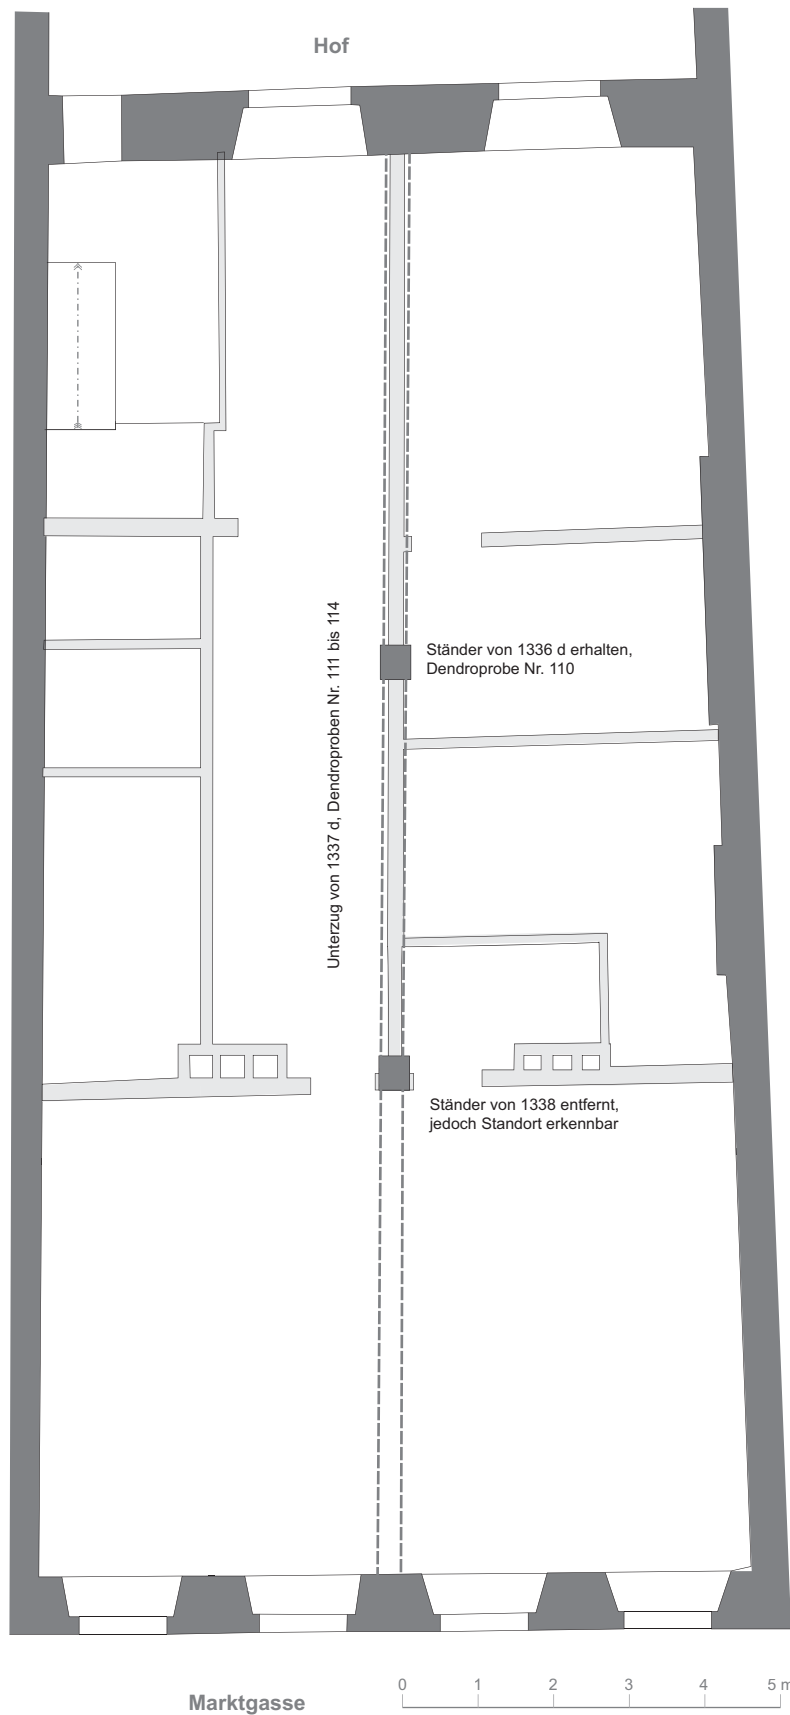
Winterthur. Marktgasse 44. Grundriss 1. Obergeschoss mit Graueintrag der jüngsten Binnenwände. M. 1:100.
